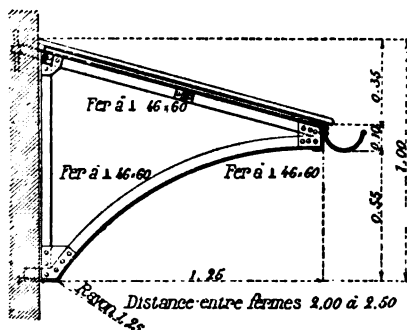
Marquise en fers à simple T assemblée par plaques en tôle.
